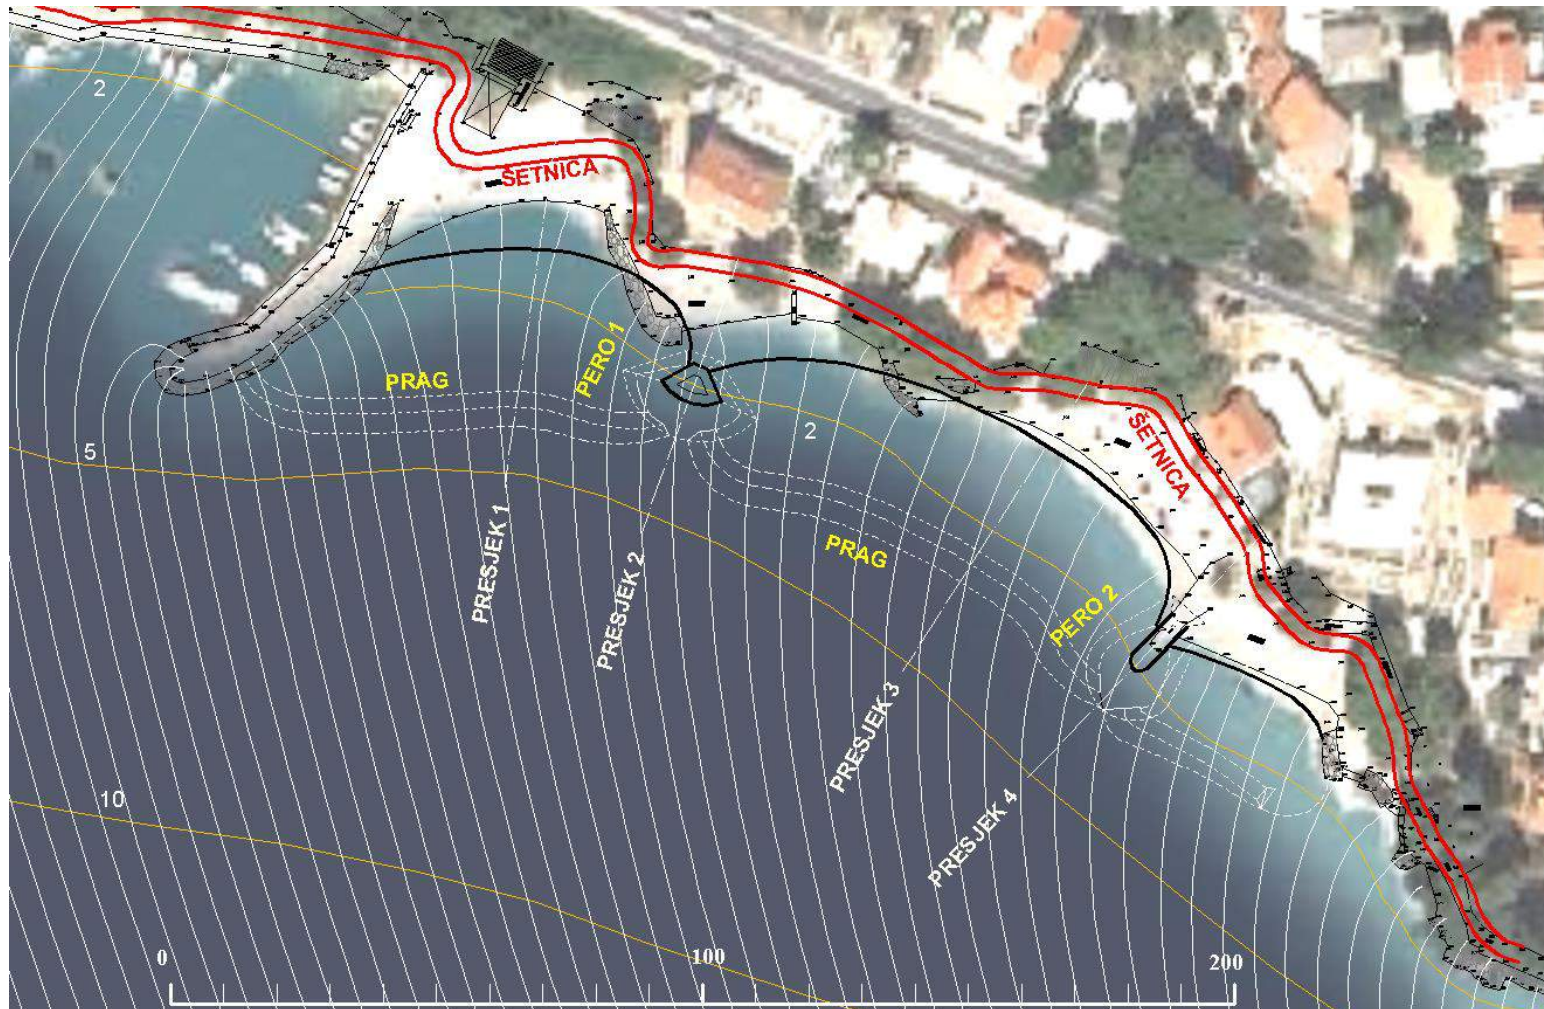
Rješenje rekonstrukcije i prihrane plaže – Varijanta B
